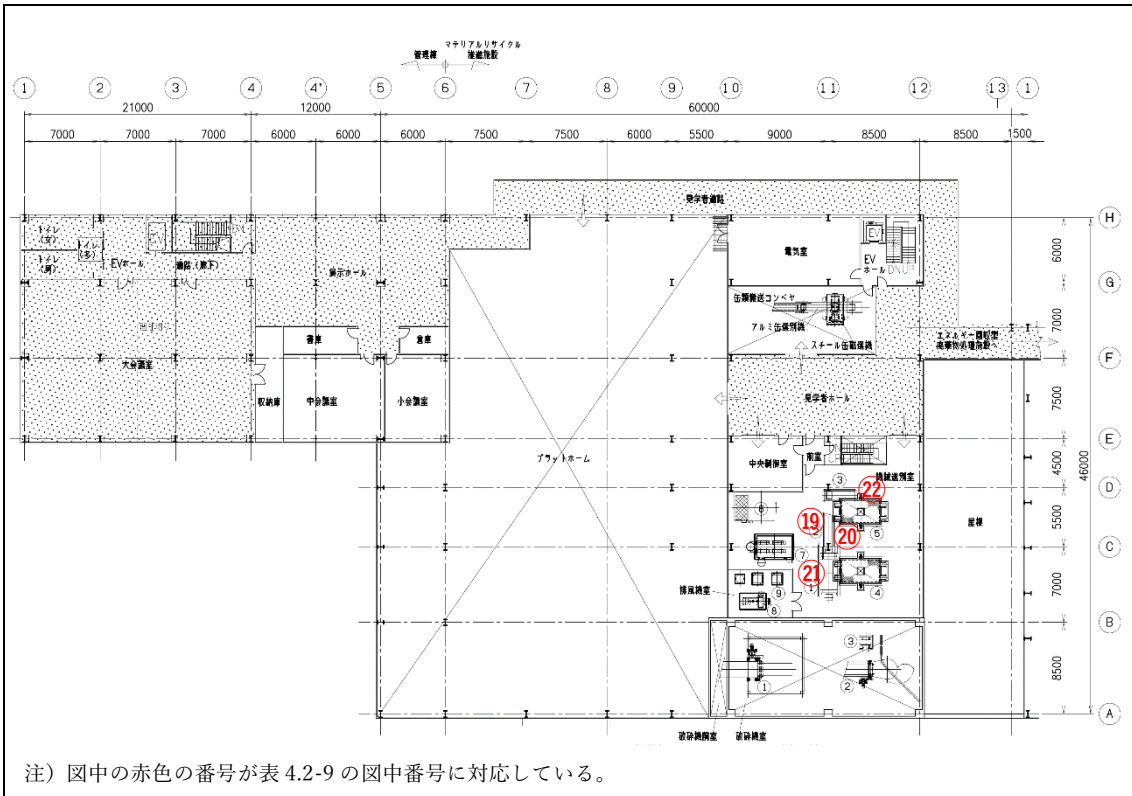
機器の配置図 (マテリアルリサイクル推進施設 2 階) (案)
